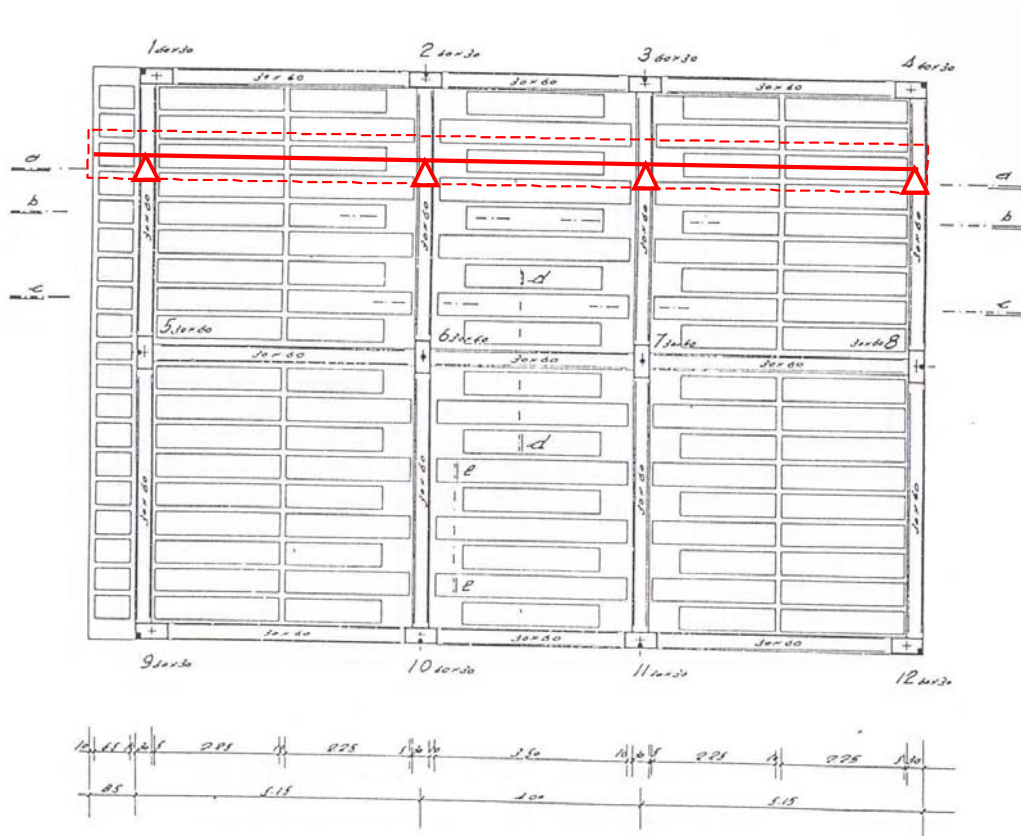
Esempio di carpenteria di solaio e corrispondente schema strutturale
